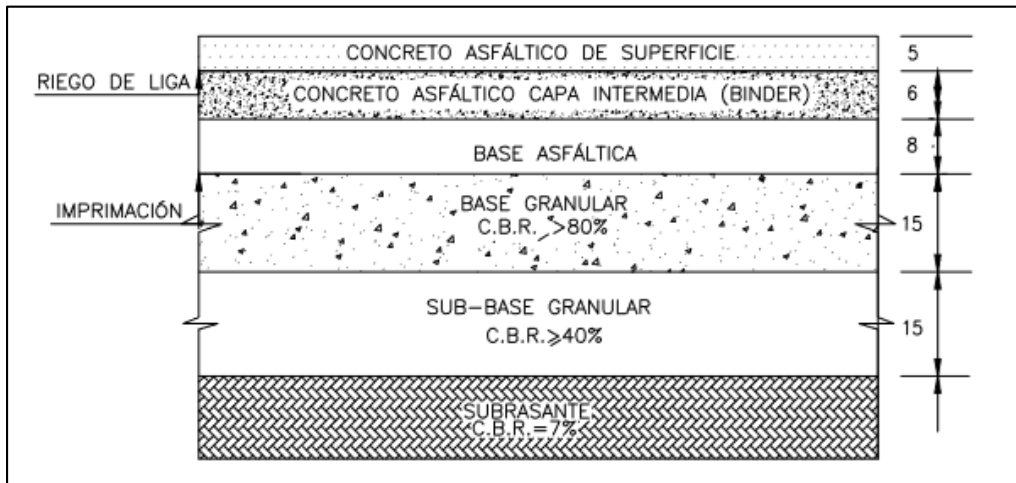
Perfil longitudinal del paquete estructural de la Ruta F-50.
